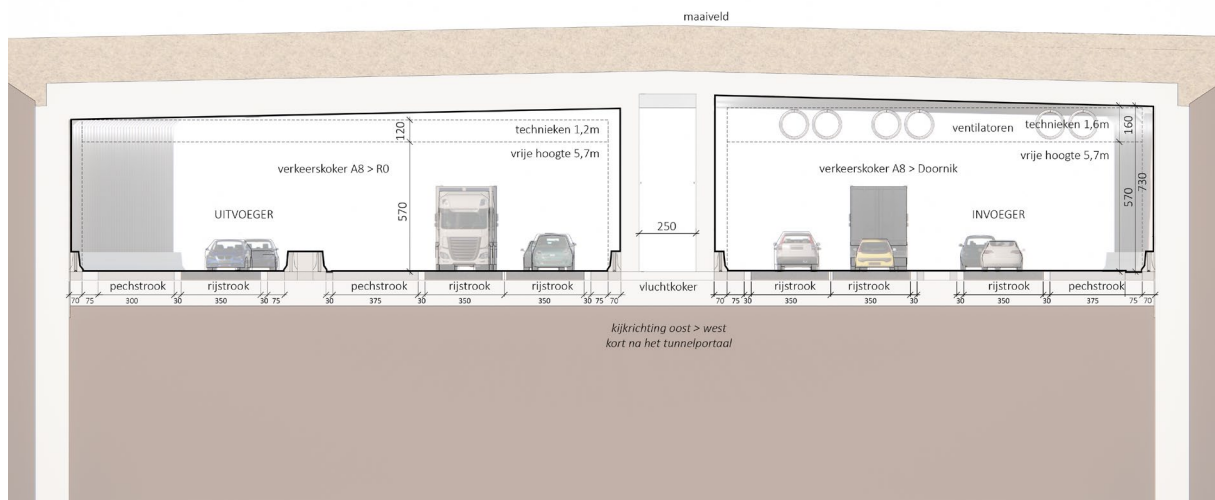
Typesnede van de tunnelkokers en tunnelwanden.
